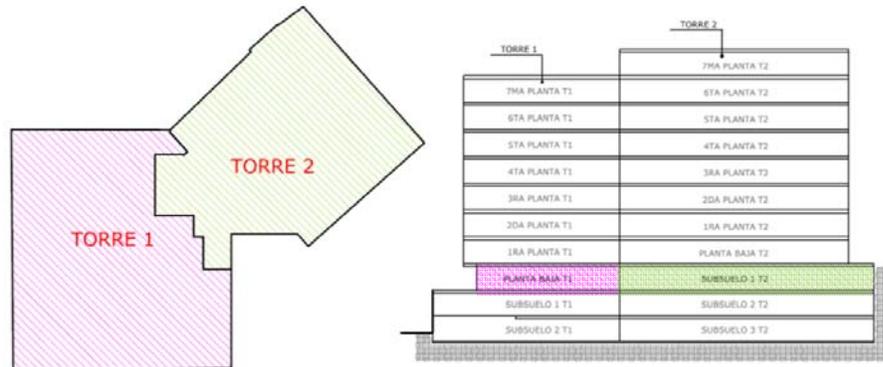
Planta Baja T1 – Subsuelo 1 T2
